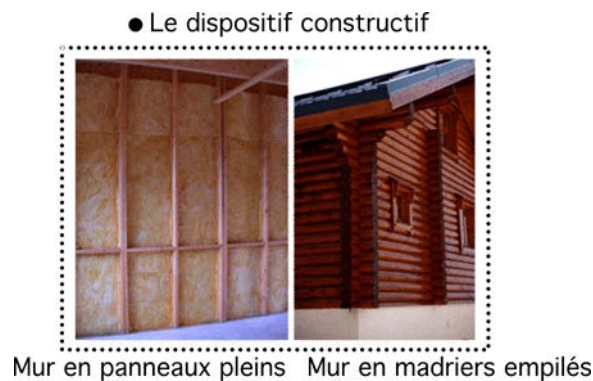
Caractéristique graphique « le dispositif constructif ».
